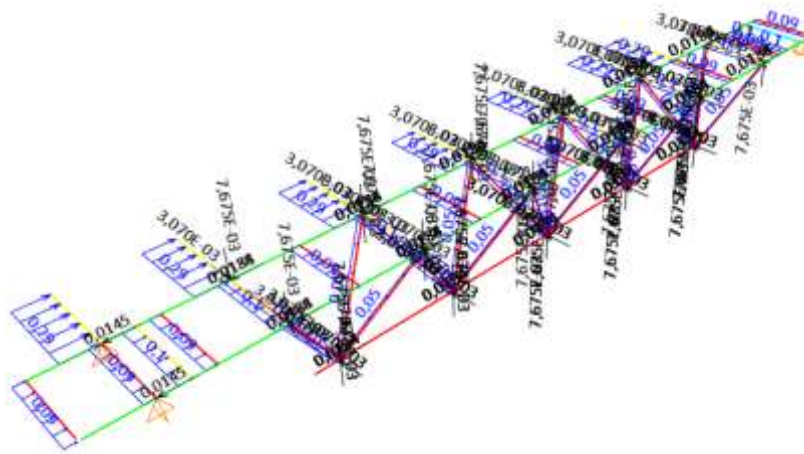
Beban Angin (WX) yang diterima Struktur *Catwalk 13
